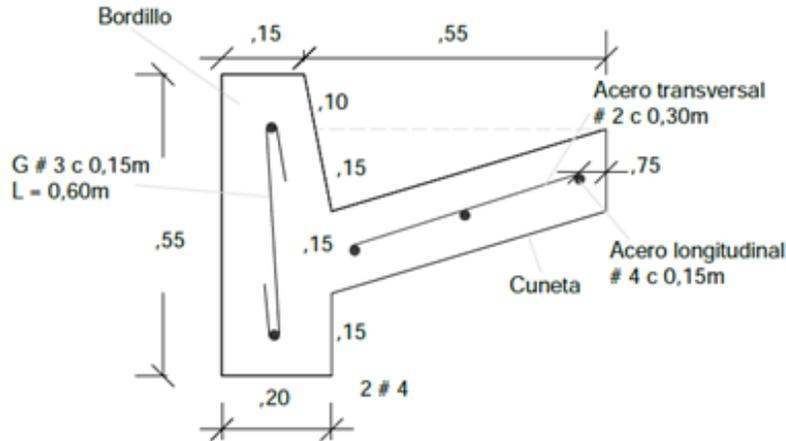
Detalle berma cuneta (Fuente: Modelo INVIAS)
